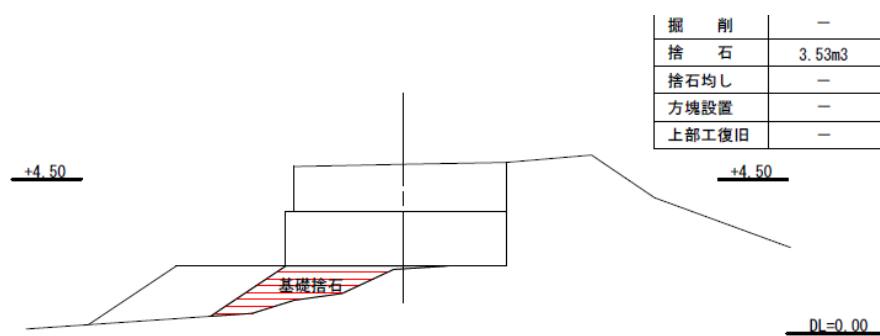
No. 8 南海浜埋立地導流堤の断面図（南側）No. 0+15.4（被災後）
